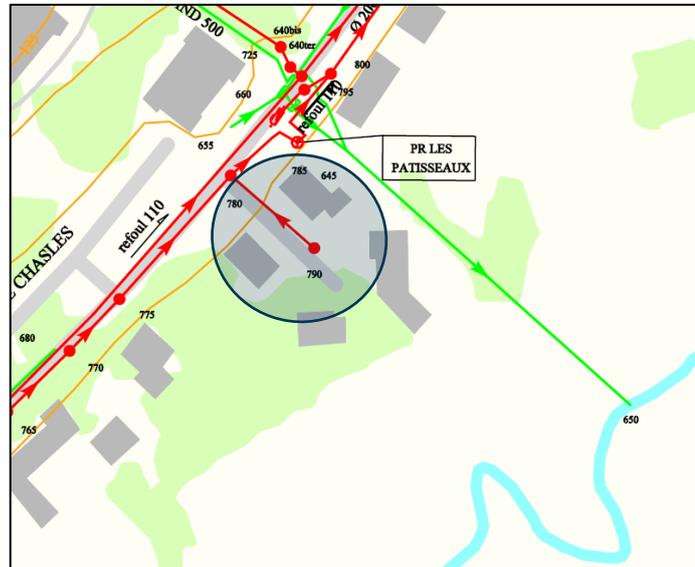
Plan du système d'assainissement pluvial d'Epernon (Secteur Sud)
